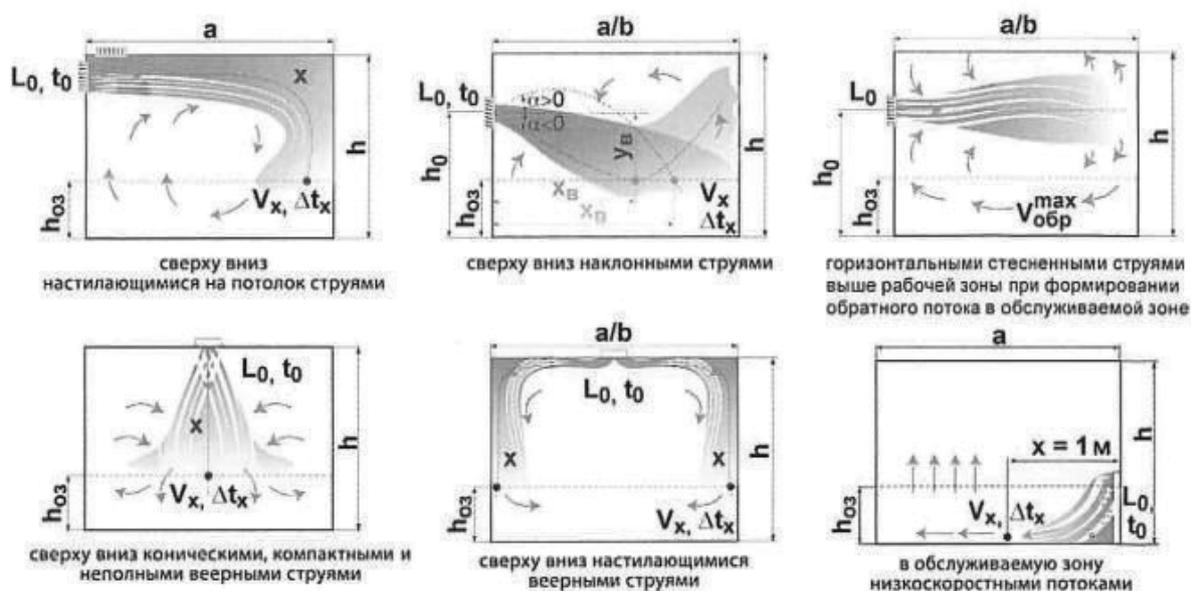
Основные схемы подачи приточного воздуха
